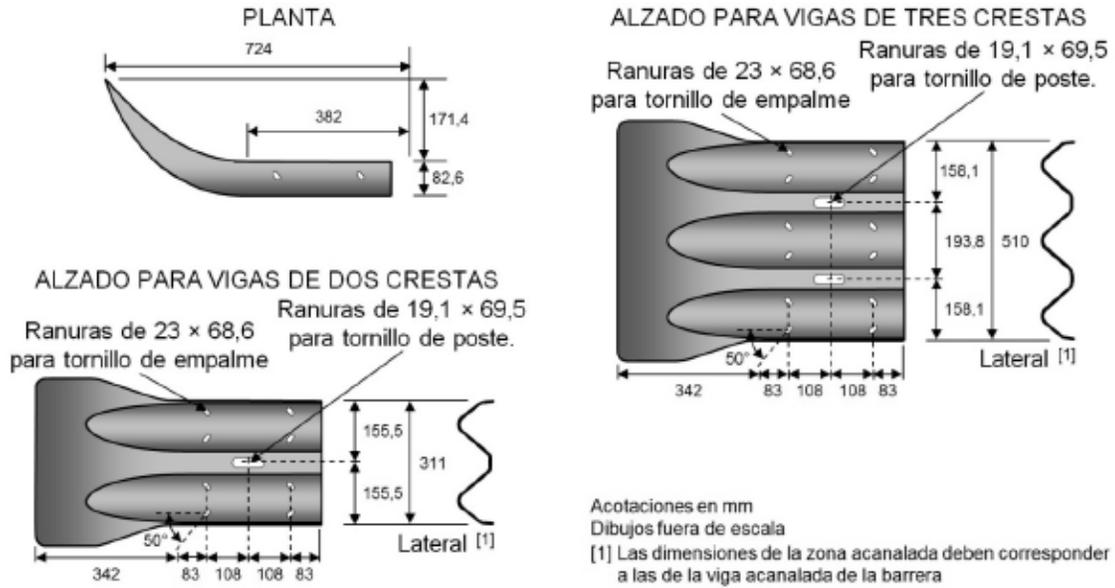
Secciones terminales sencillas para vigas acanaladas de dos y de tres crestas (OD-4.4.2/S)
